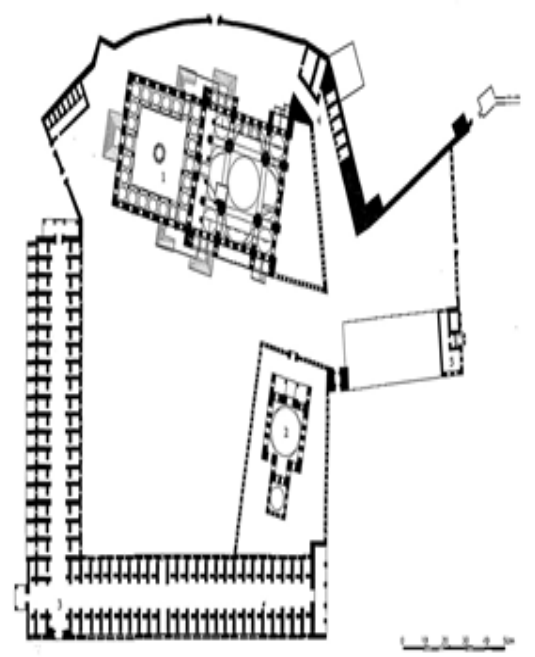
مسقط أفقى كلية شهزاده محمد
